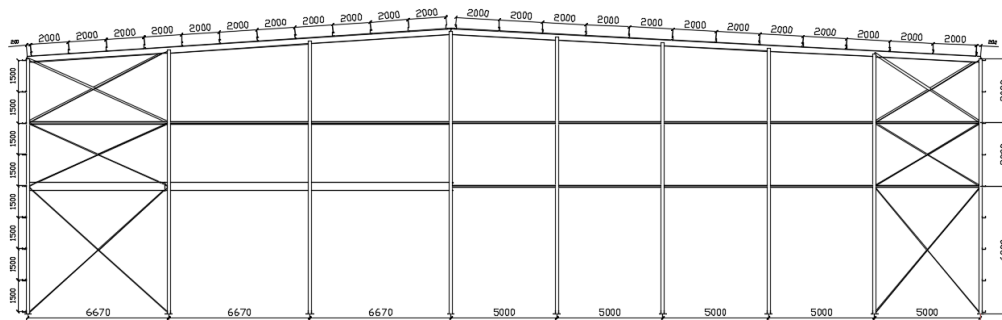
Pórtico de fachada A con correas en cubierta y laterales. (Fuente: Creación Propia)
